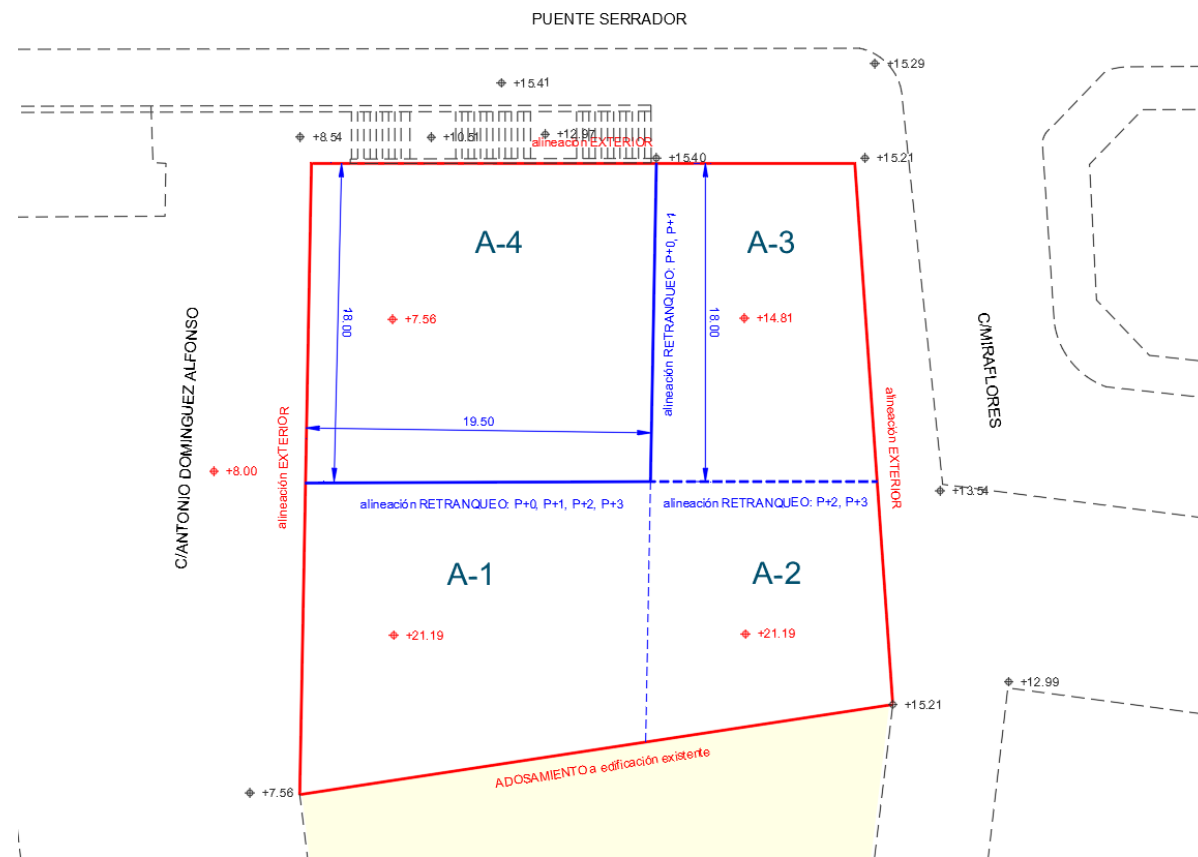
Rasantes propuestas en el Estudio de Detalle
